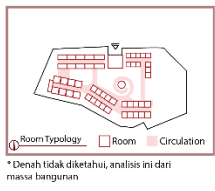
38 Konfigurasi massa bangunan dan ruangan
